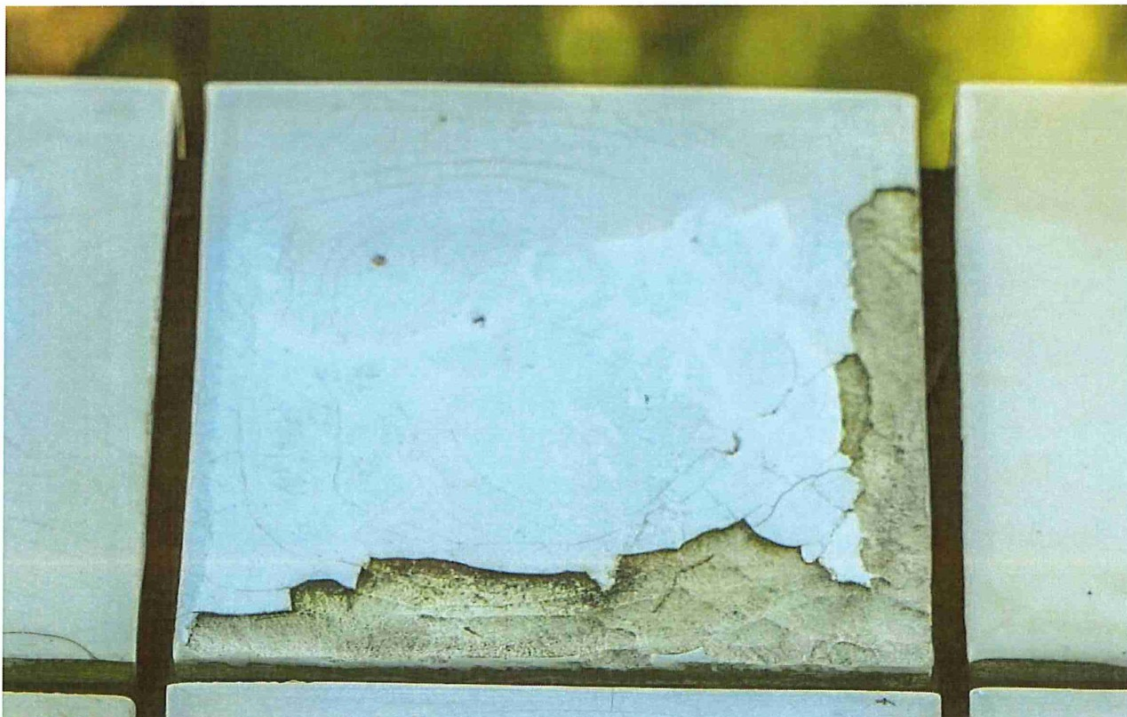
Plafondtegels (dus geen regenbelasting) onder de doorgang naar de tussenverdieping waarin haarscheuren aanwezig zijn (zie foto 4 voor een detail).
